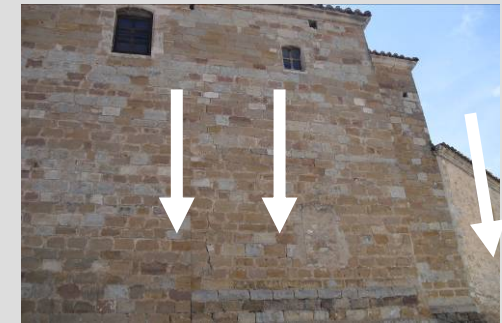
Fisuras verticales exteriores (nave y trasagrario)
